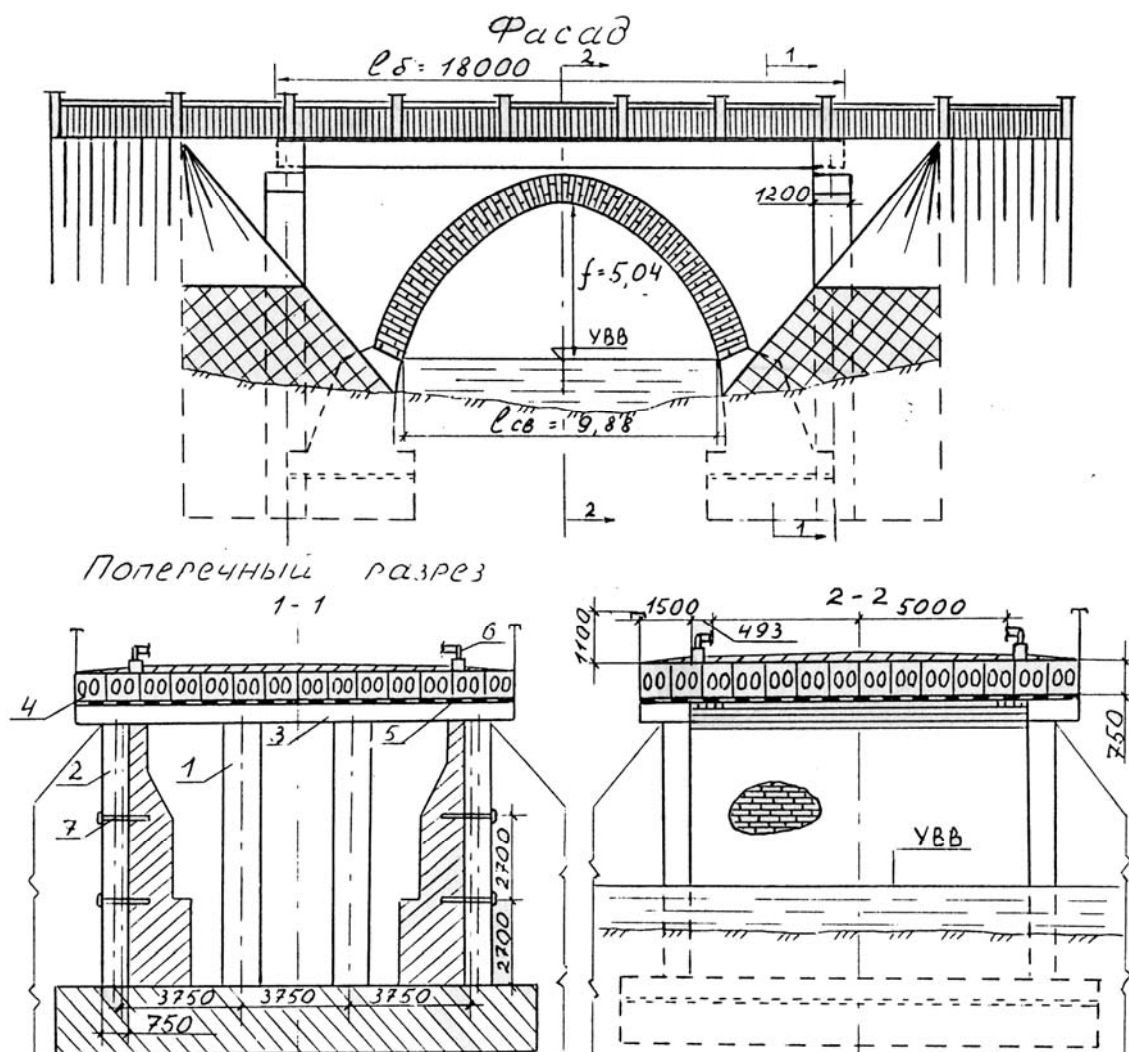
Реконструкция арочного моста через реку Студенец на ул. Базарной в г. Тамбове: 1 – сваи - оболочки  $d=1,2$  м; 2 – крайние стойки; 3 – ригель; 4 – плитные блоки пролетного строения; 5 – опорные части; 6 – барьерные ограждения; 7 – анкерные болты
